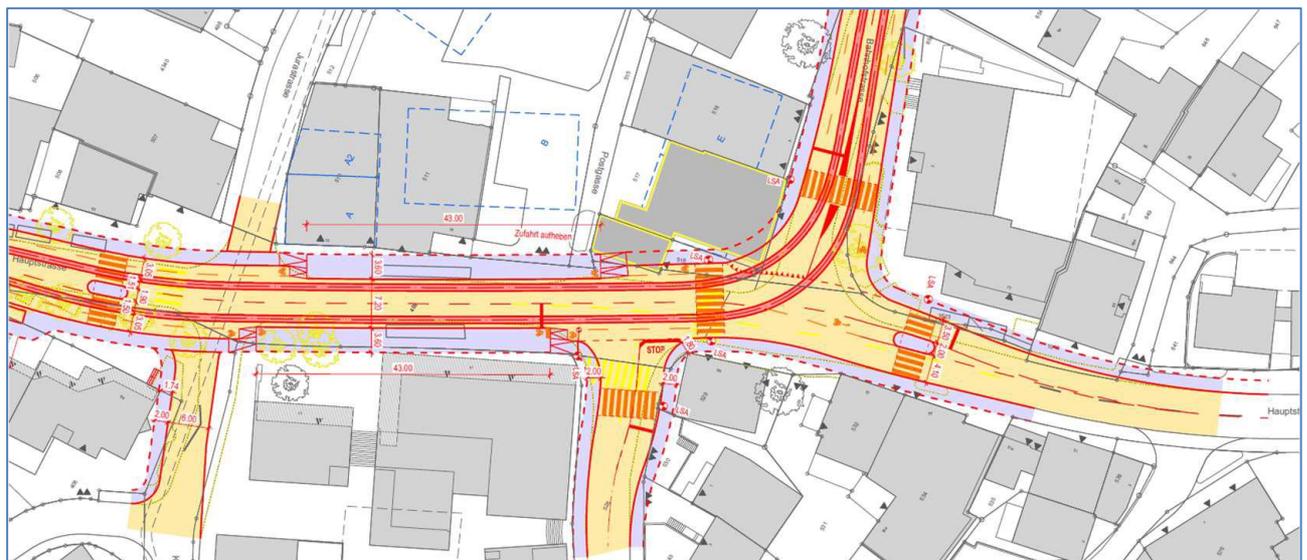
Situation Abschnitt Mühle / Knoten Hauptstrasse – Bahnhofstrasse
